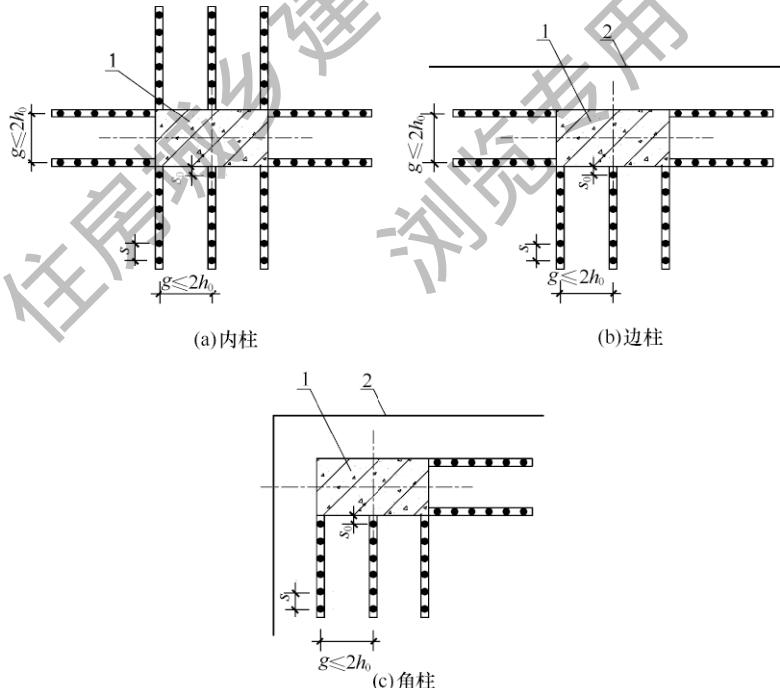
矩形柱周边抗冲切锚栓排列示意
